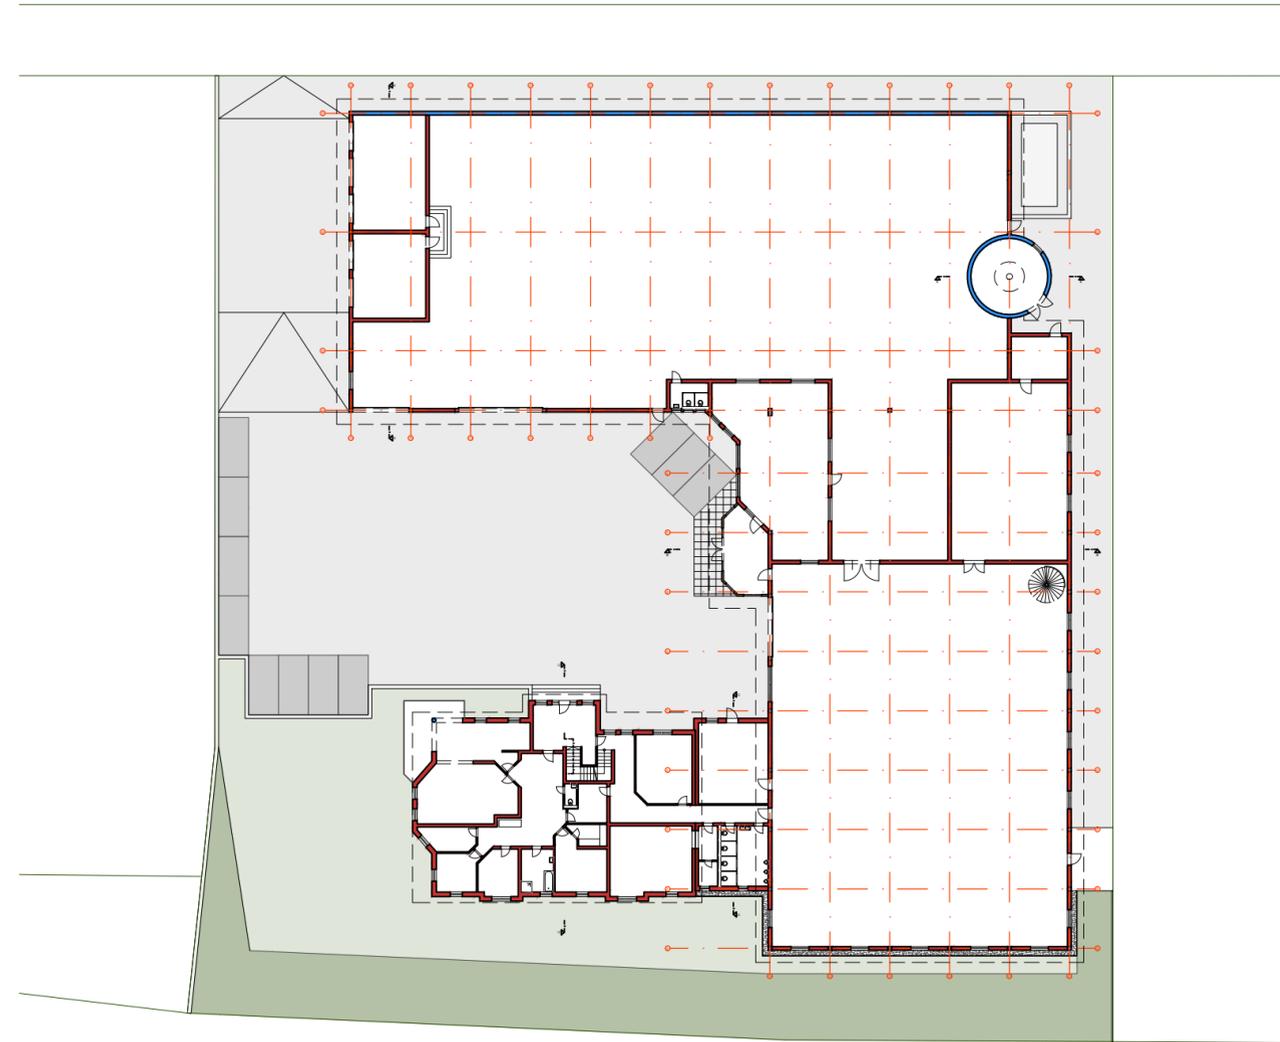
Grundriss Erdgeschoß lt. Einreichung 1995
